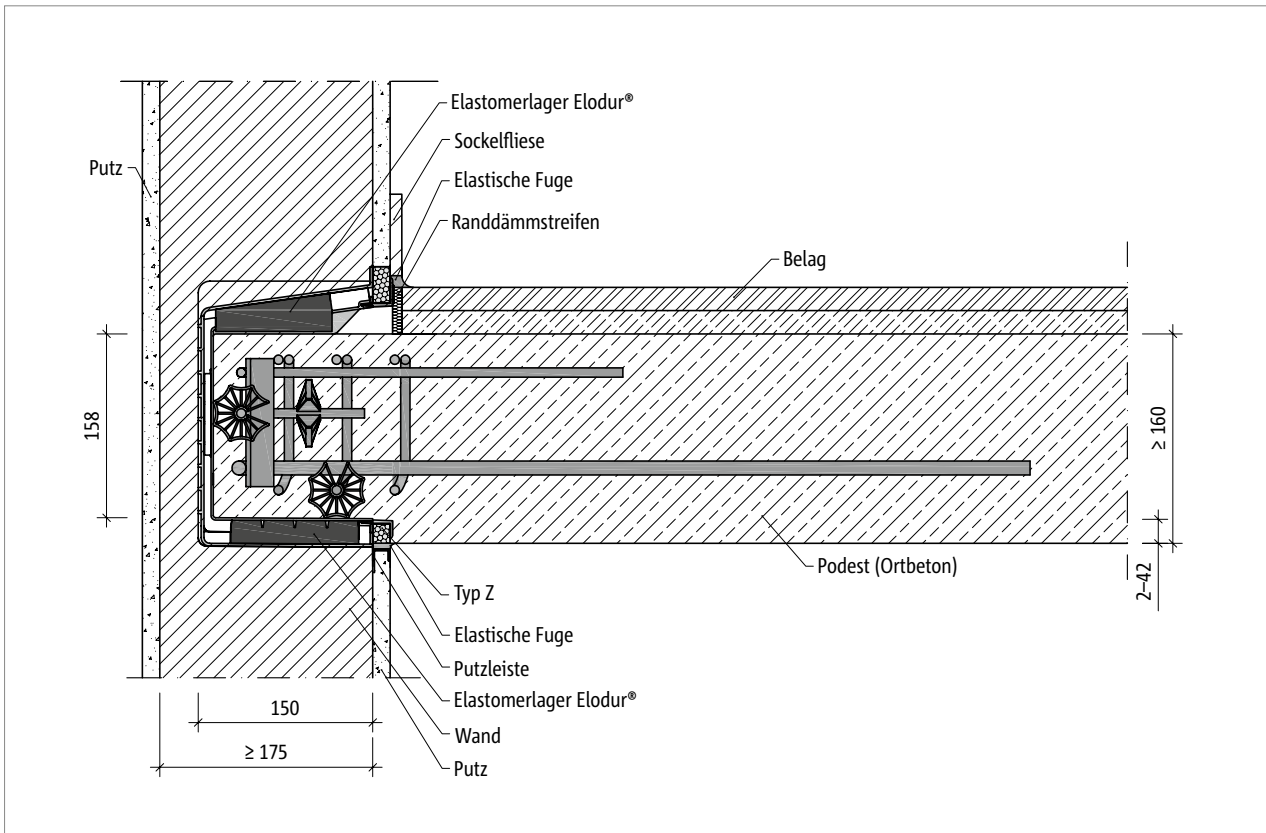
Schöck Tronsole® Typ Z-V+V-T: Einbauschnitt Ortbetonpodest
